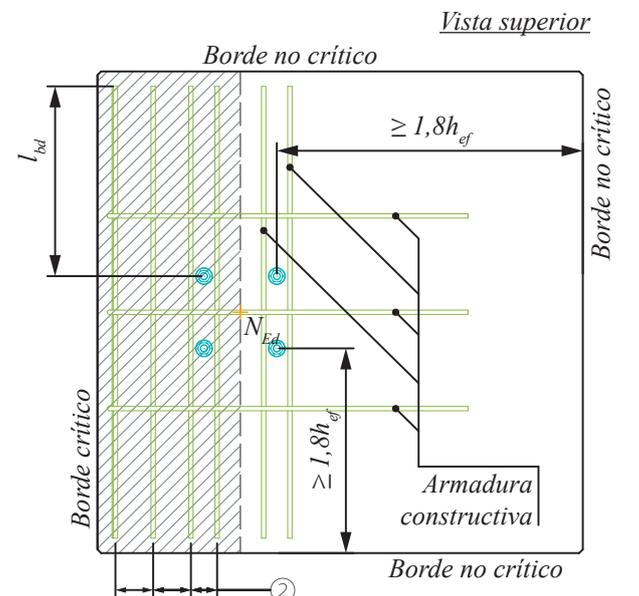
Detalle para la armadura de fisuración. Un caso con un borde crítico.
